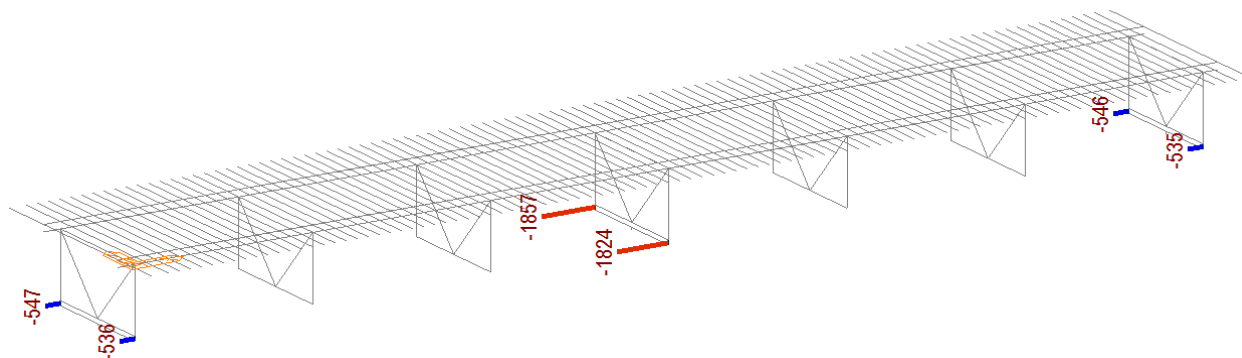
Betonážní úsek 1 (min. přitlak 30 kN, Podpěra 3)
